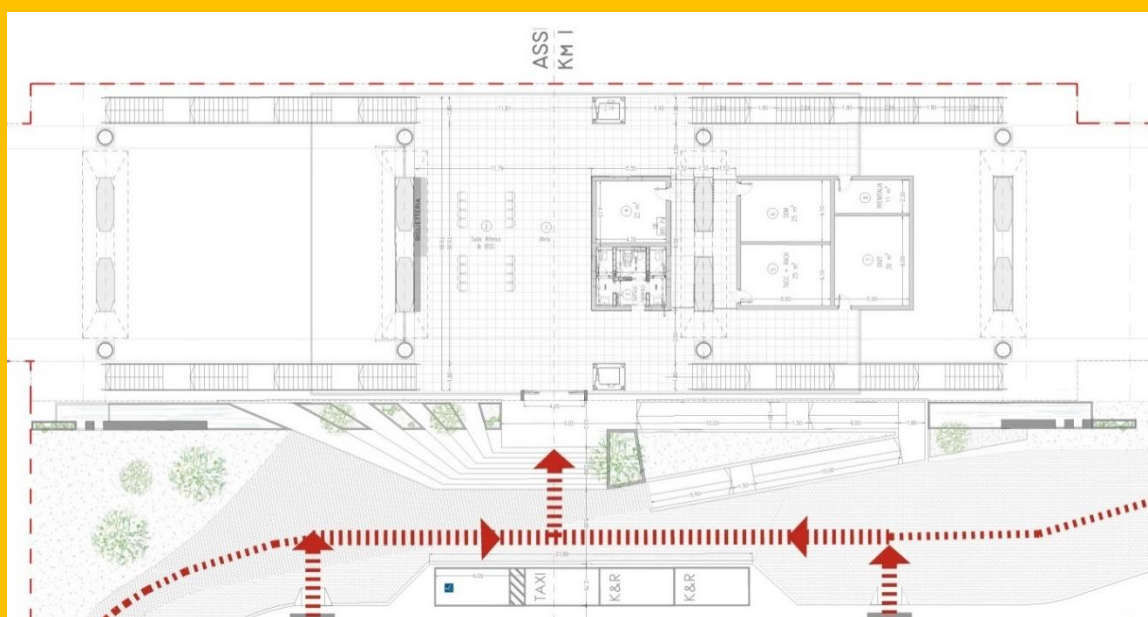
Pianta piano terra e accesso dal piazzale antistante
